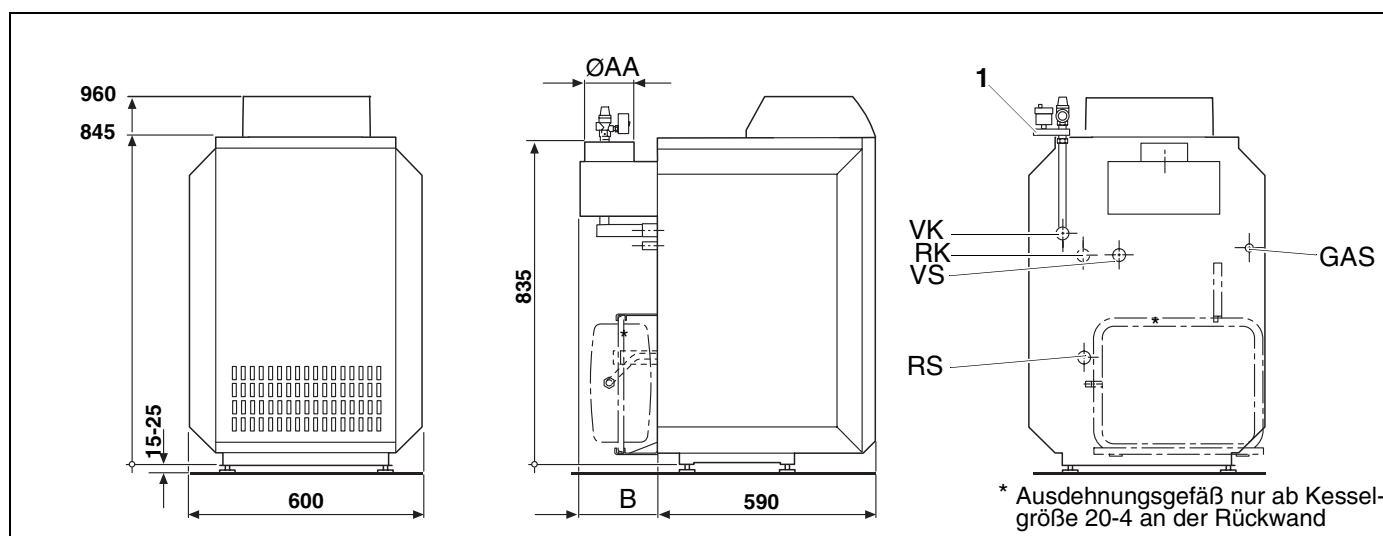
Anschlüsse und Abmessungen für G144 V (Maße in mm)
